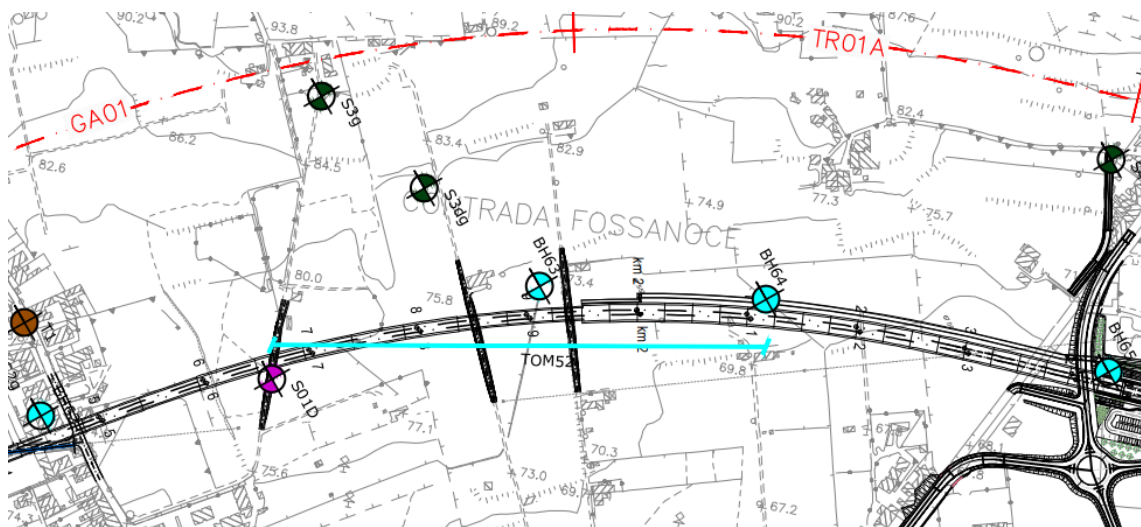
Stralcio della planimetria con ubicazione dei sondaggi BH62-BH65
